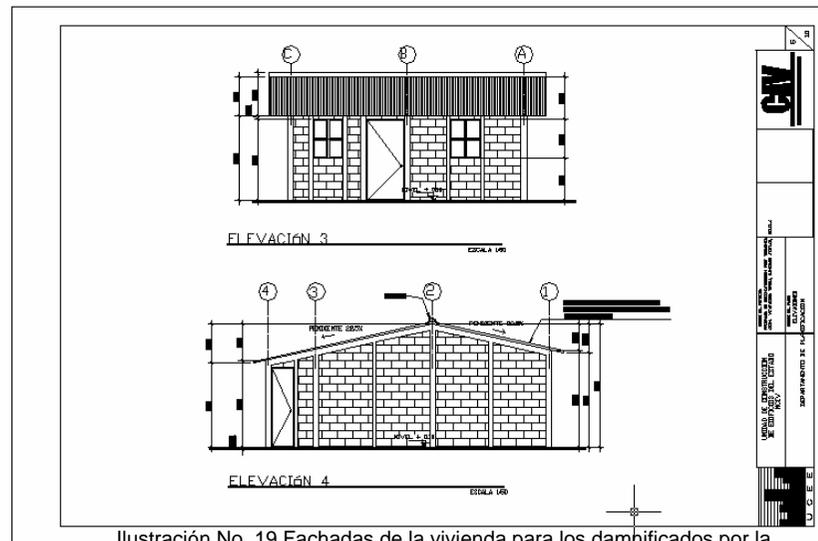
Fachadas de la vivienda para los damnificados por la Tormenta Stan del Municipio de Santiago Atitlán. Fuente: FOGUAVI
